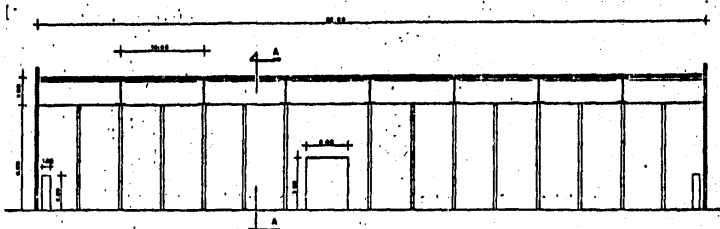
VISTA PLANTA DE LA FABRICA (AREAS DE ALIMENTACION)
